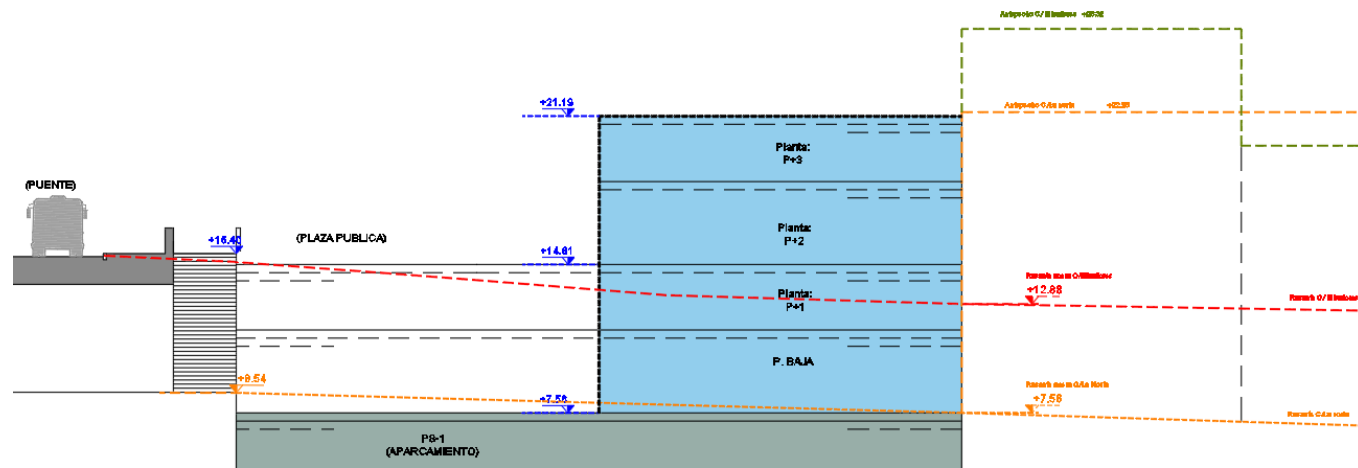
Sección transversal al Puente Serrador propuesta del volumen edificable
